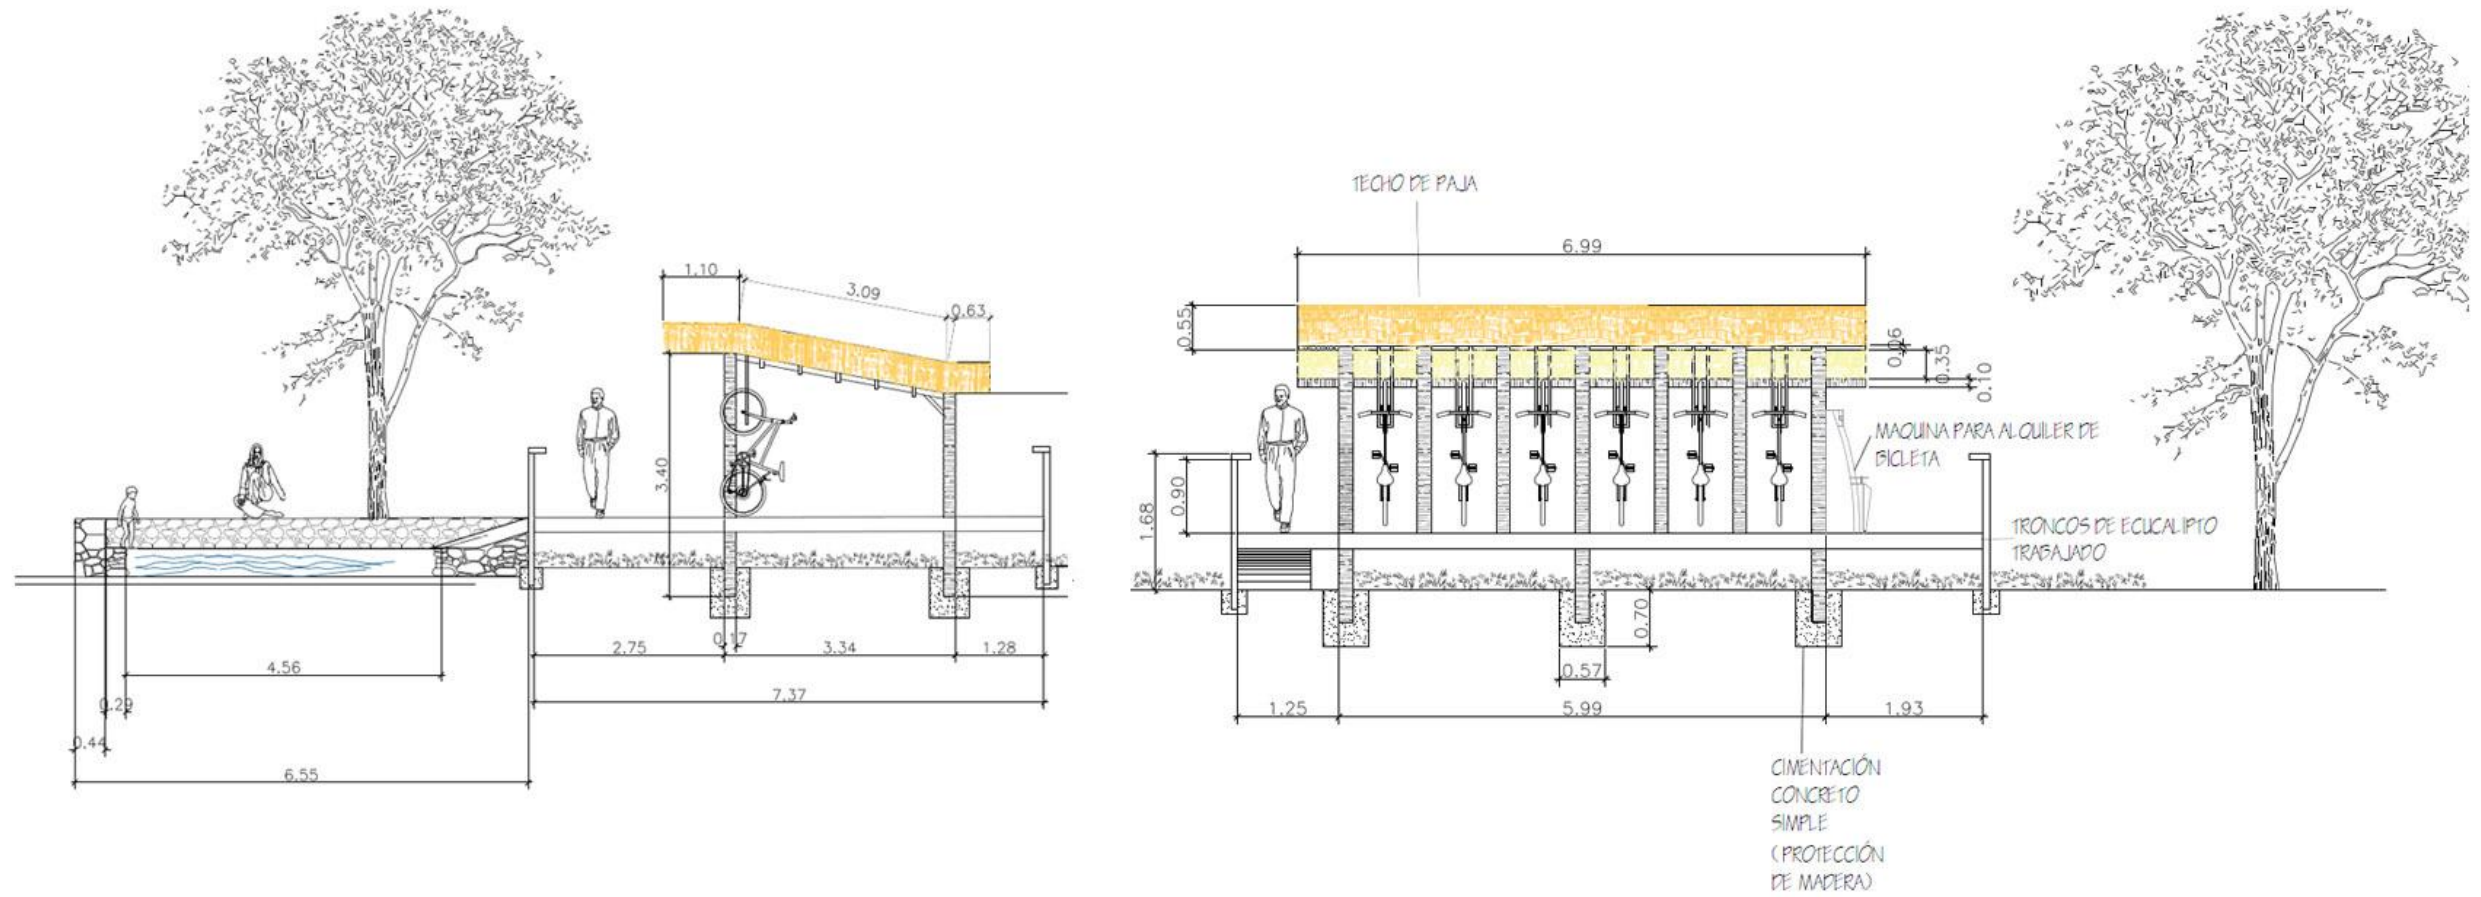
Paradero de ciclovías propuestas”, corte y detalles. Fuente Elaboración propia.
